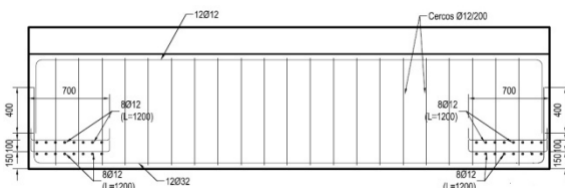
Esquema de armado longitudinal viga de junta entre cajones.
